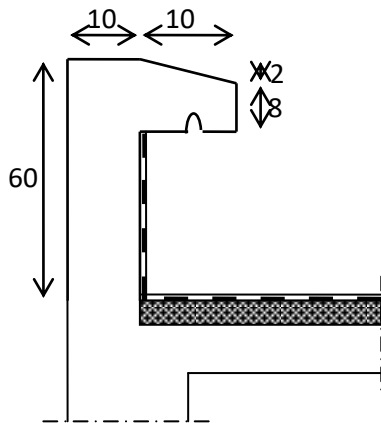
Type 1 :L'acrotère pour terrasse inaccessible.
